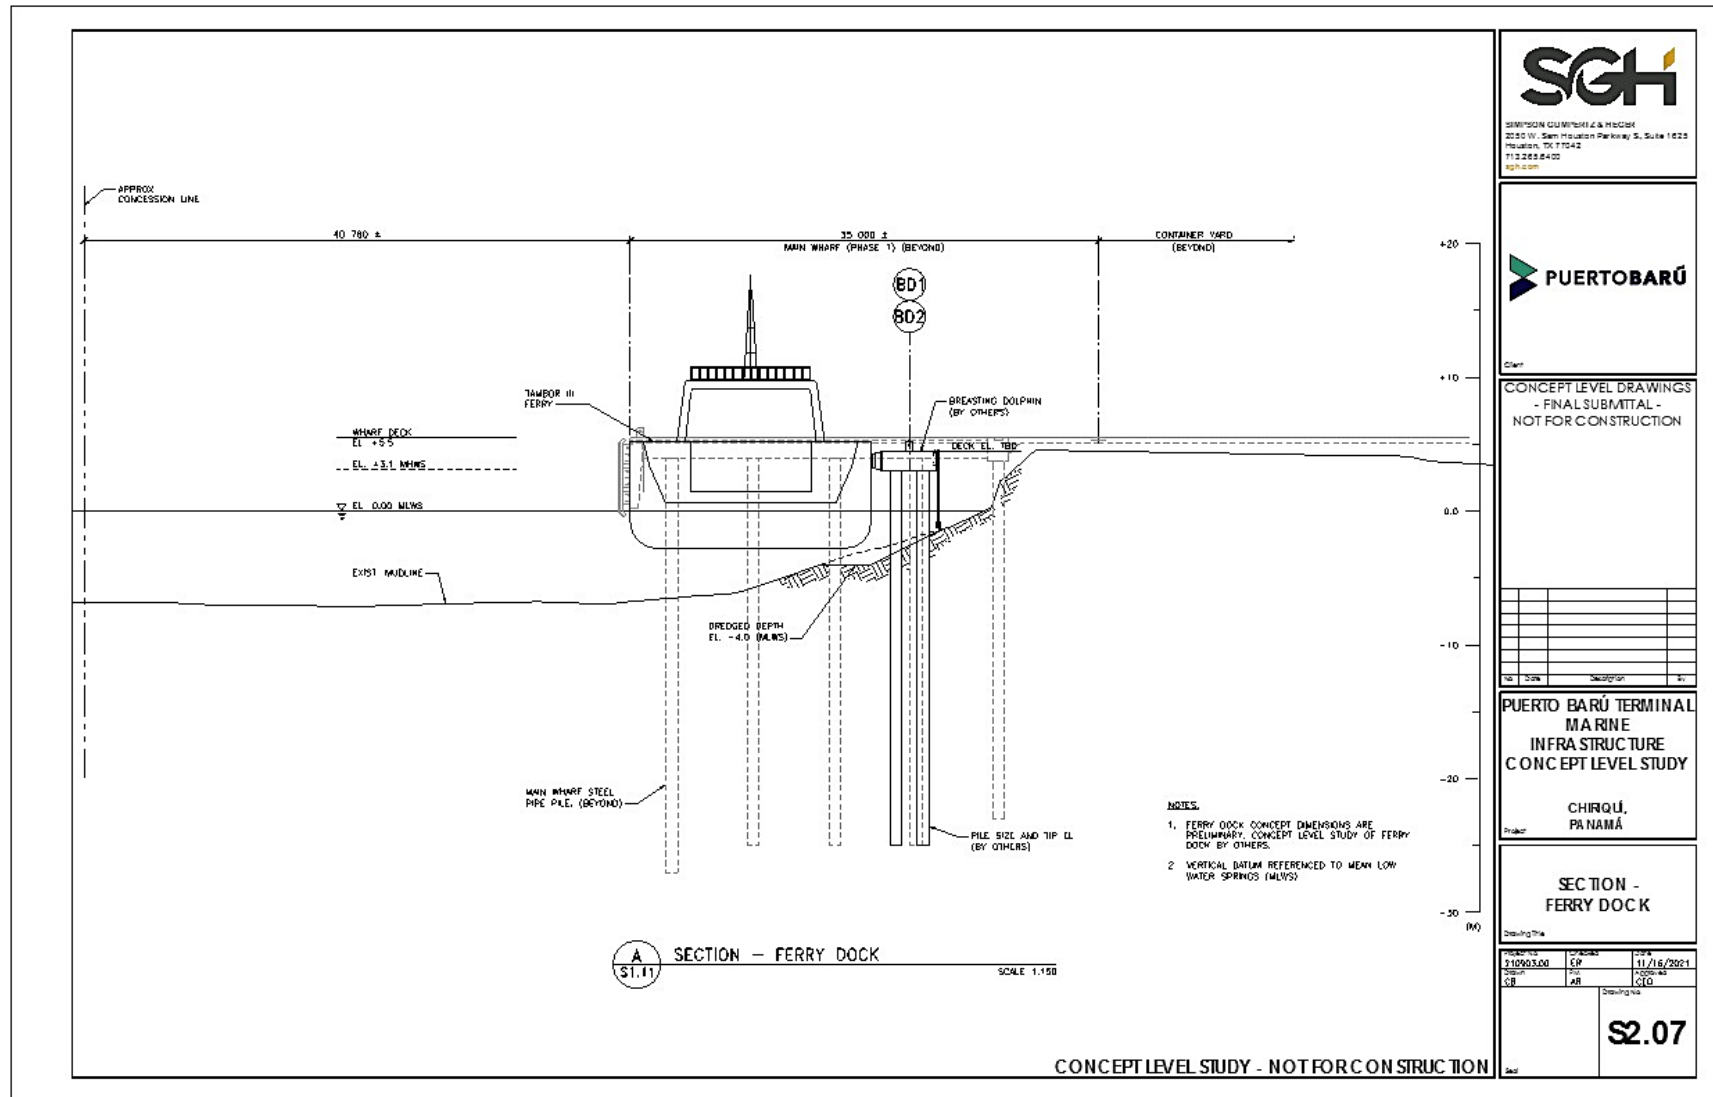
Detalle de Pilotes propuestos (aún en diseño el material de los pilotes).
